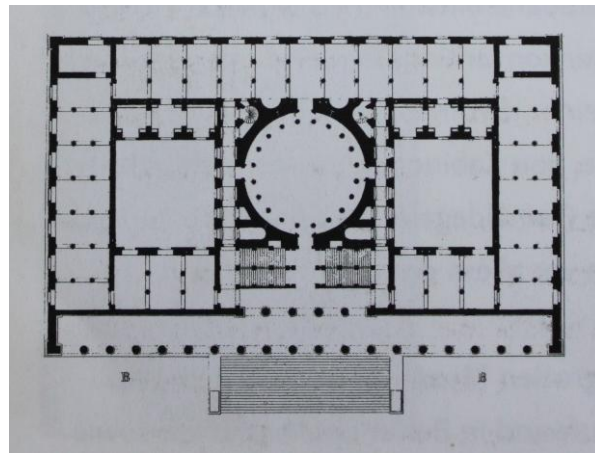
Berlin, Altes Museum (Karl Friedrich Schinkel, 1823-30), Grundriss Erdgeschoß
